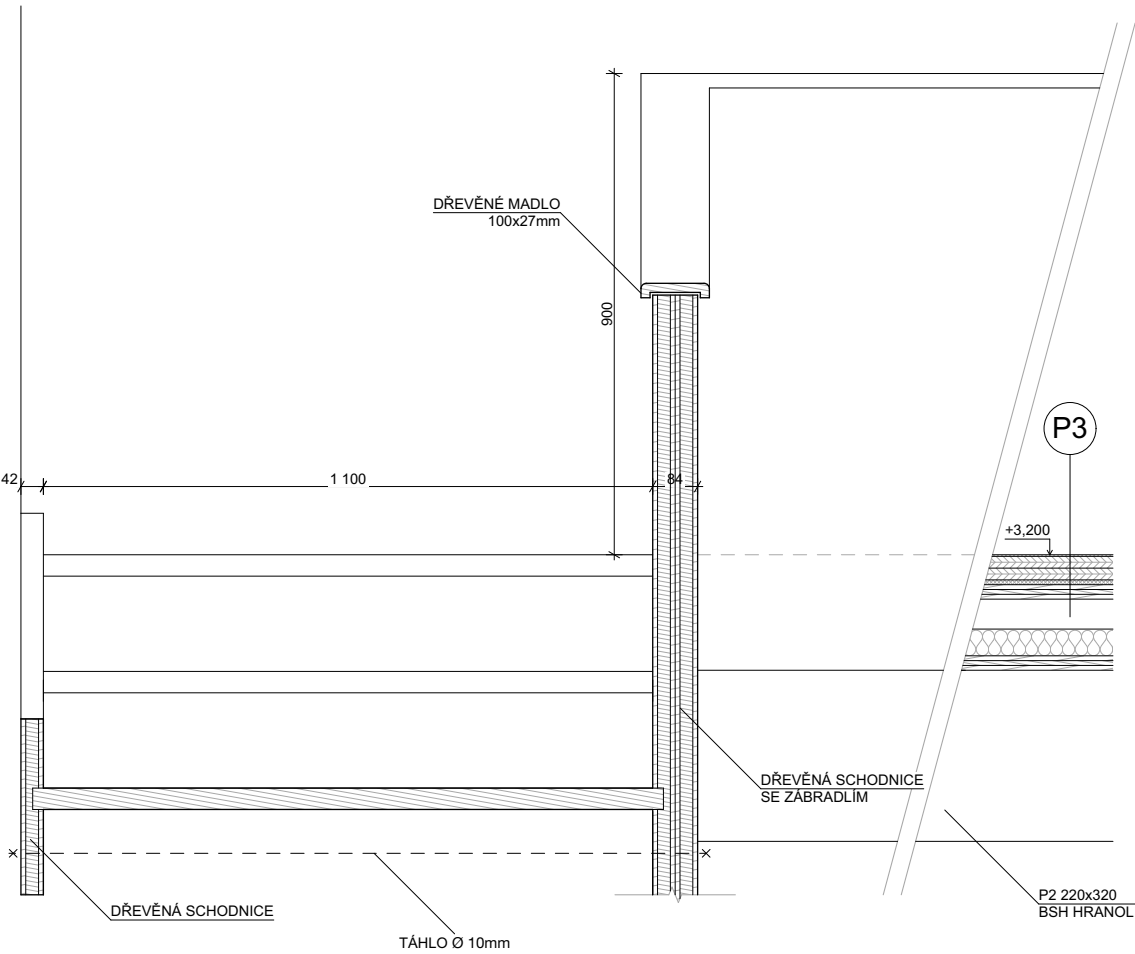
DETAIL SCHODIŠŤOVÝCH STUPŇŮ M1:5
